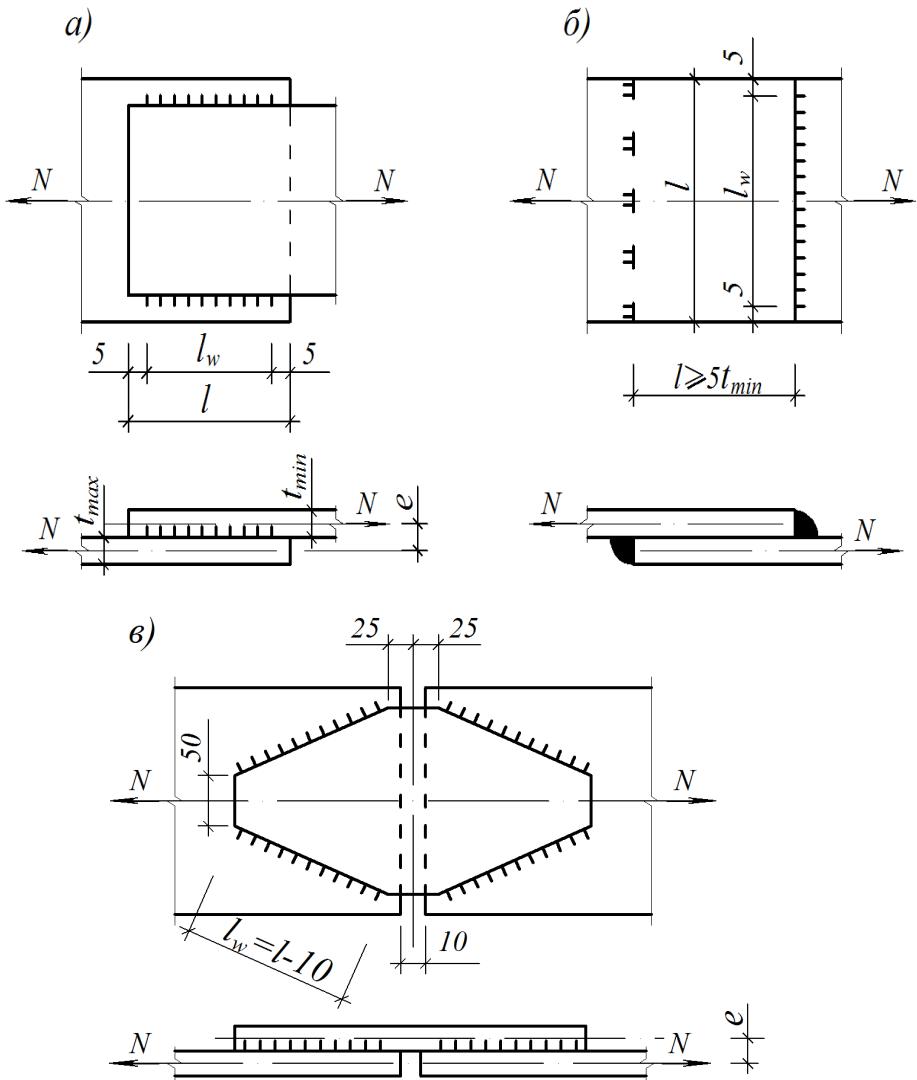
Типы сварных швов в нахлесточных соединениях:
